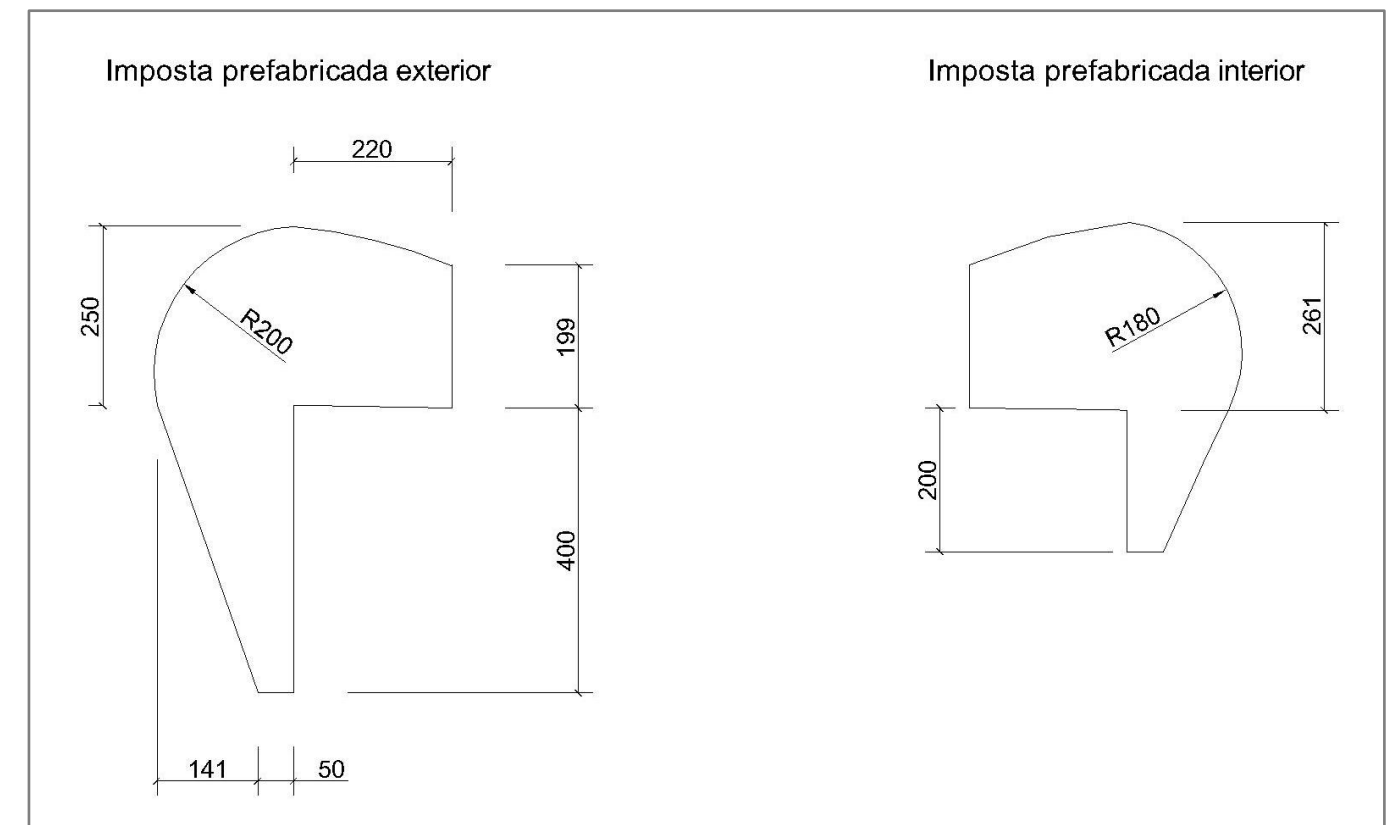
Imposta prefabricada exterior e interior. Fuente: elaboración propia. Cotas en mm.
